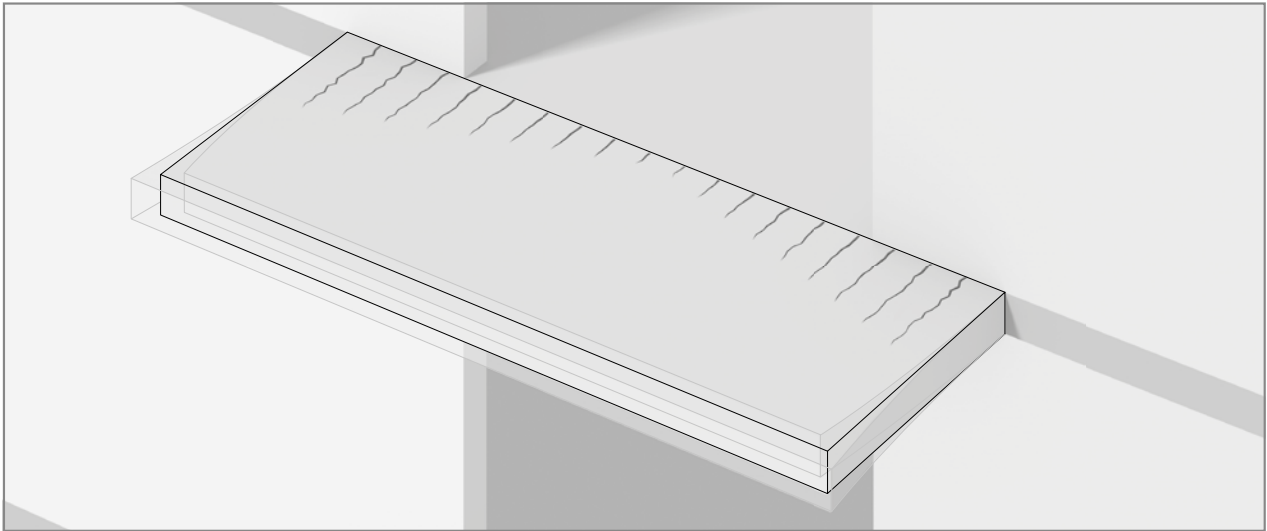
Schöck Isokorb® T typ KL: Ohybová štiřlost
